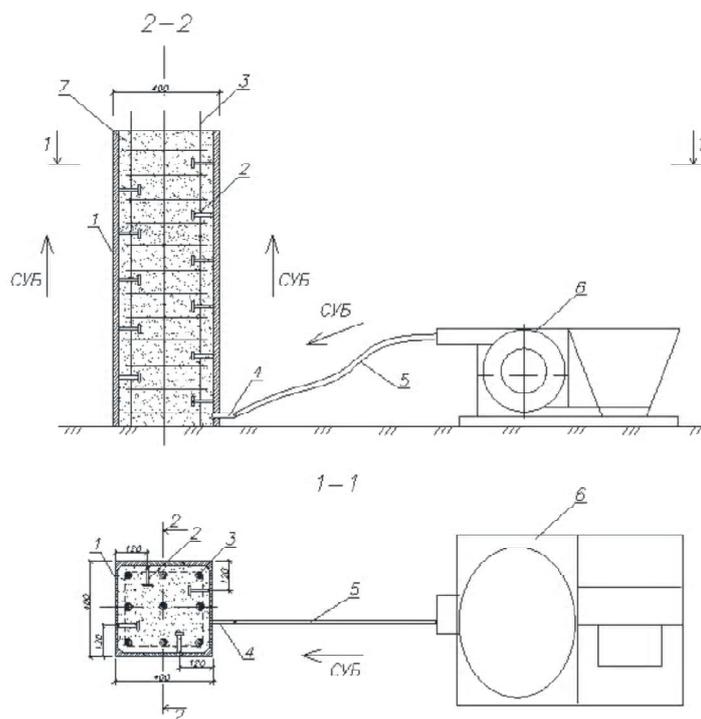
Окончание бетонирования сталежелезобетонной колонны: 1 – арматура-опалубка; 2 – анкерный упор; 3 – продольная гибкая арматура; 4 – штуцер; 5 – шланг для подачи бетона; 6 – роторный насос; 7 – самоуплотняющийся бетон.
